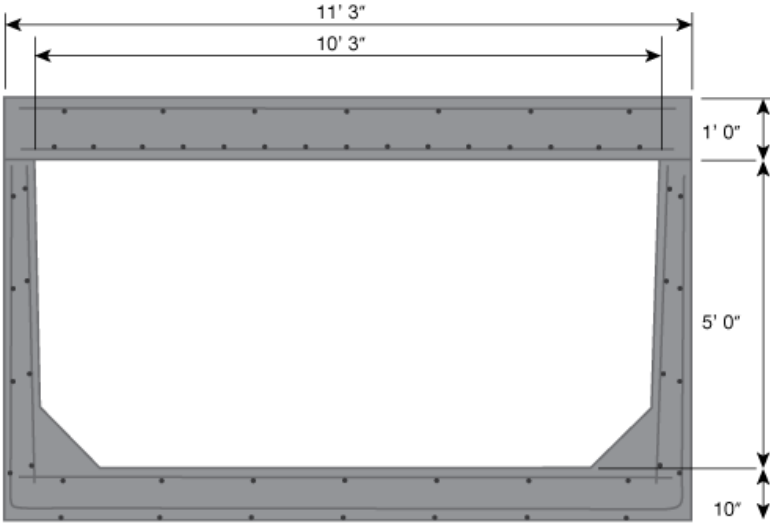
Box culvert prefabricado – FHWA⁸. Department of transportation
